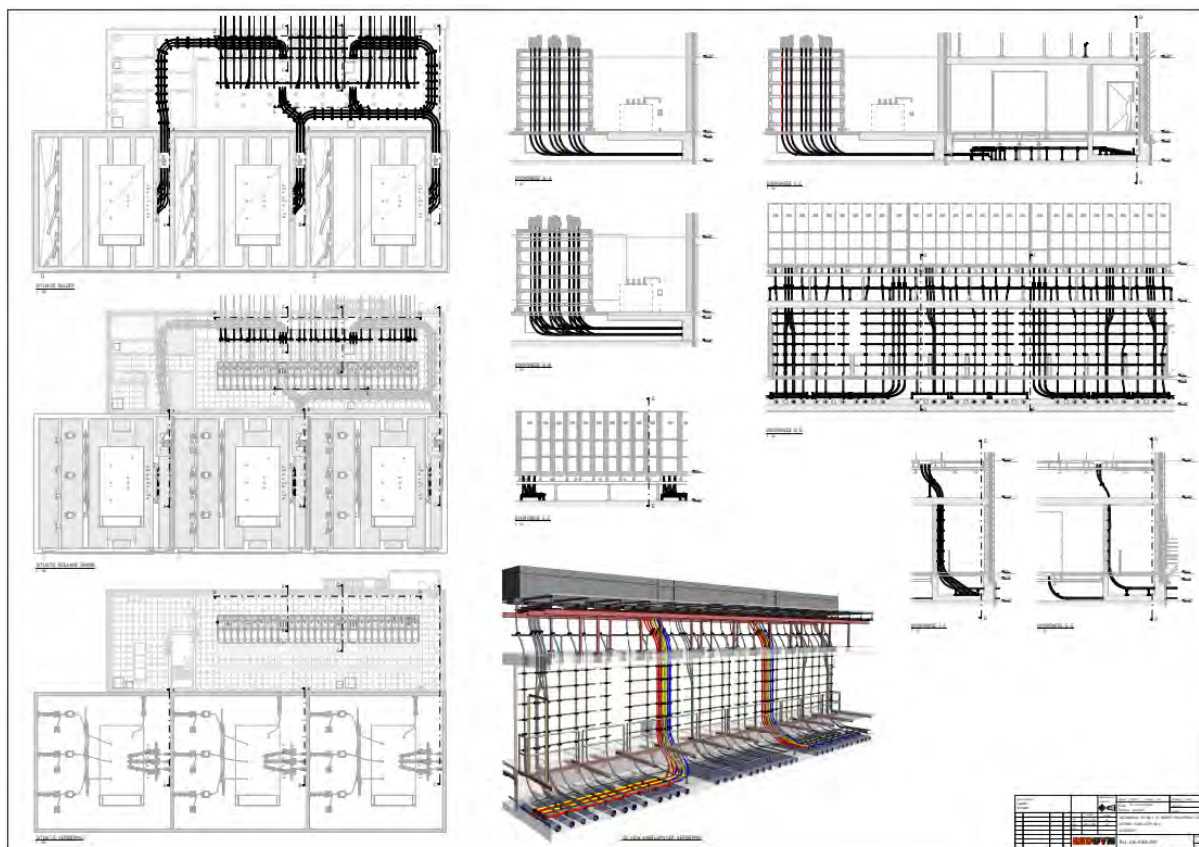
Zijaanzicht schakelhal 10 kV installatie 1.
